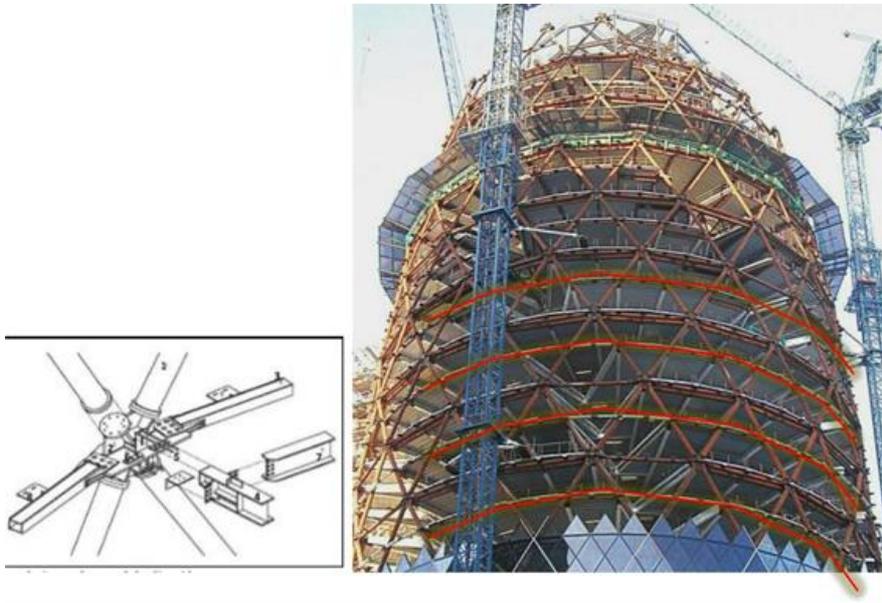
la jonction du plancher mixte avec une barre de diagrïde
